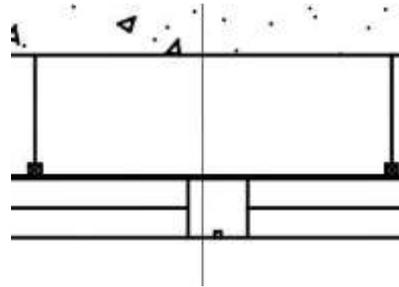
Detail Raised Floor (Sumber: Penulis, 2020)
